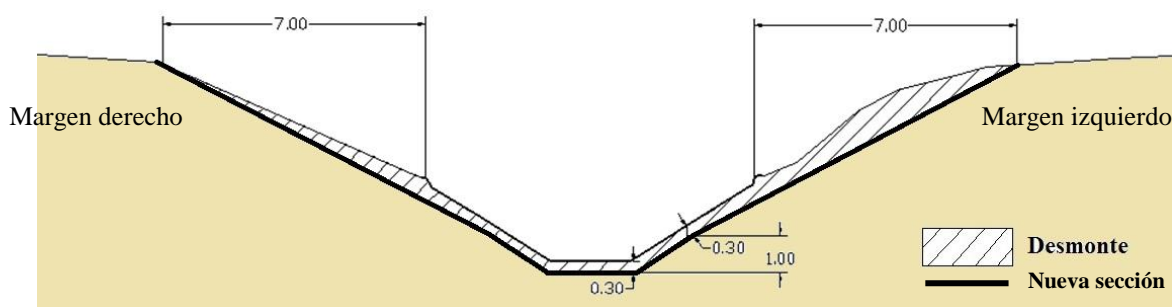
Perfil tipo para el tramo comprendido entre las secciones 450 y 300. Elaboración propia
